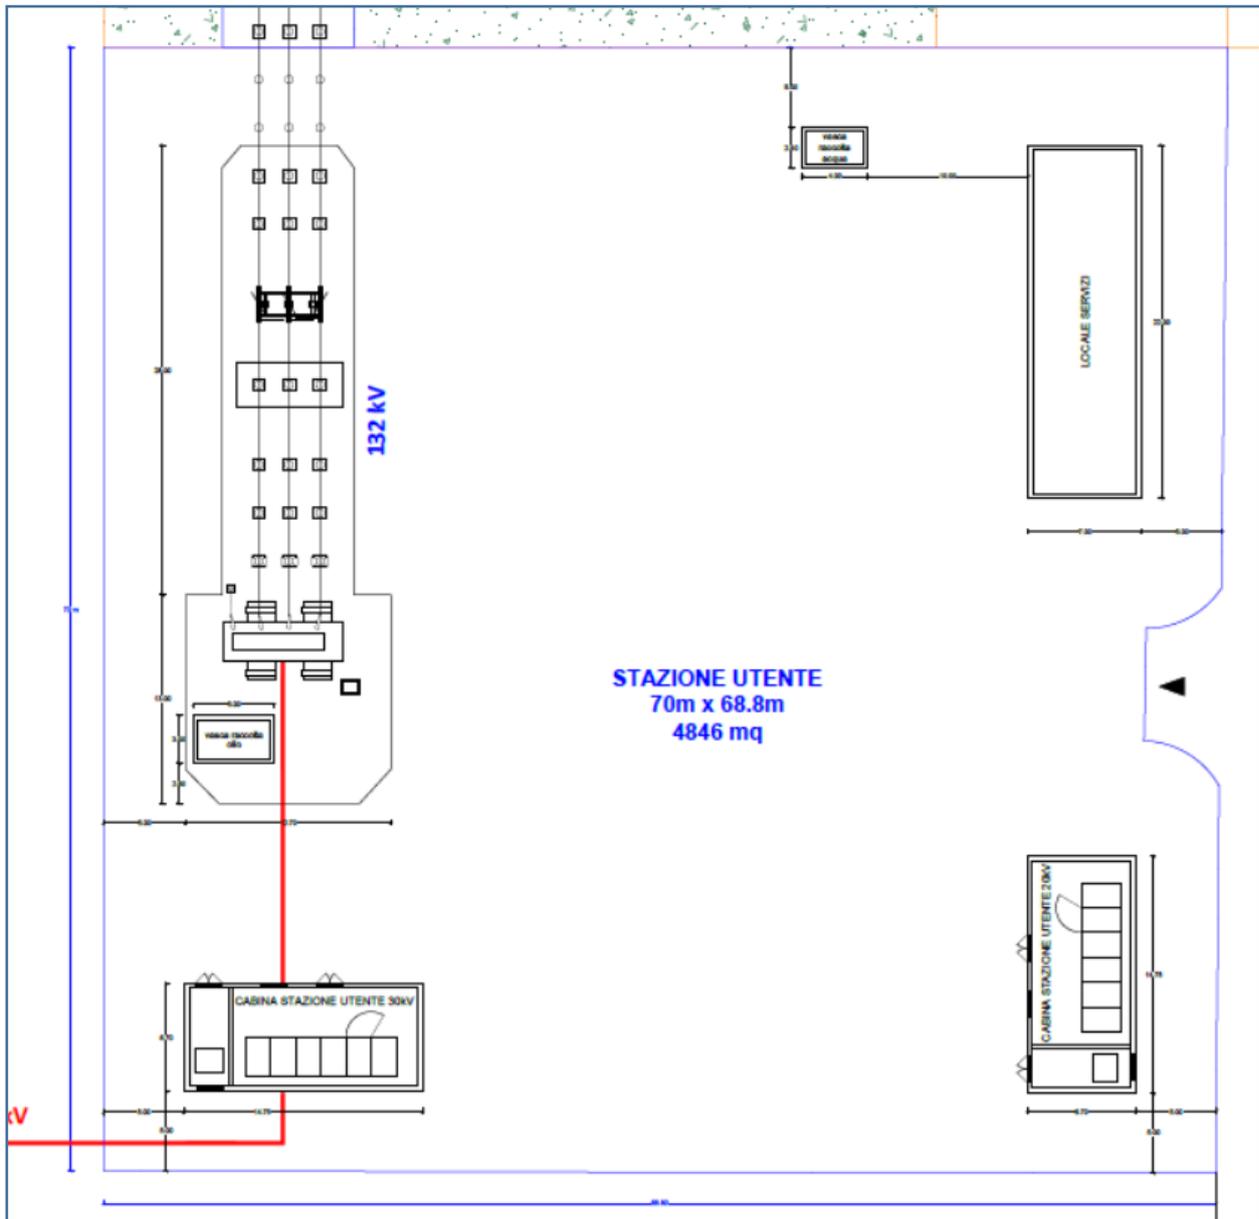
PLANIMETRIA STAZIONE UTENTE PRESSO CP MEZZOLARA
